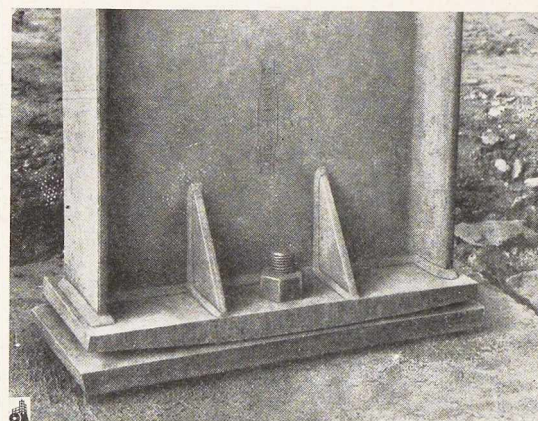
Détail d'un pied de colonne assemblé par soudure à l'arc.
